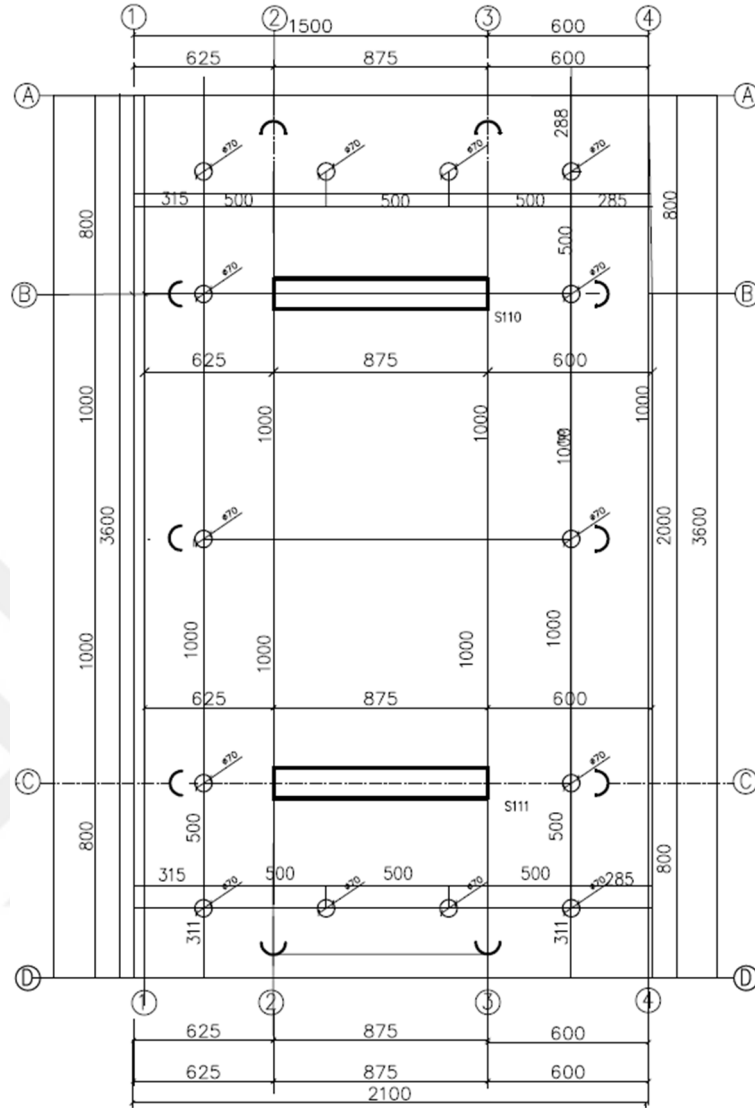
Çerçeve numunelere ait temel aplikasyon planı [124].
